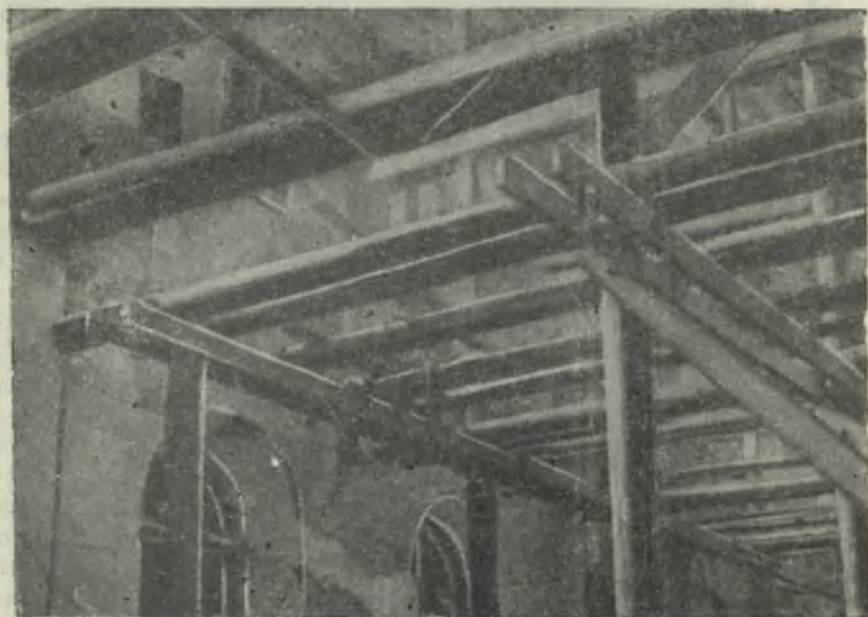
Конструкция упоров и внутренних лесов, установленных в аварийной зоне здания Ленэнерго.
